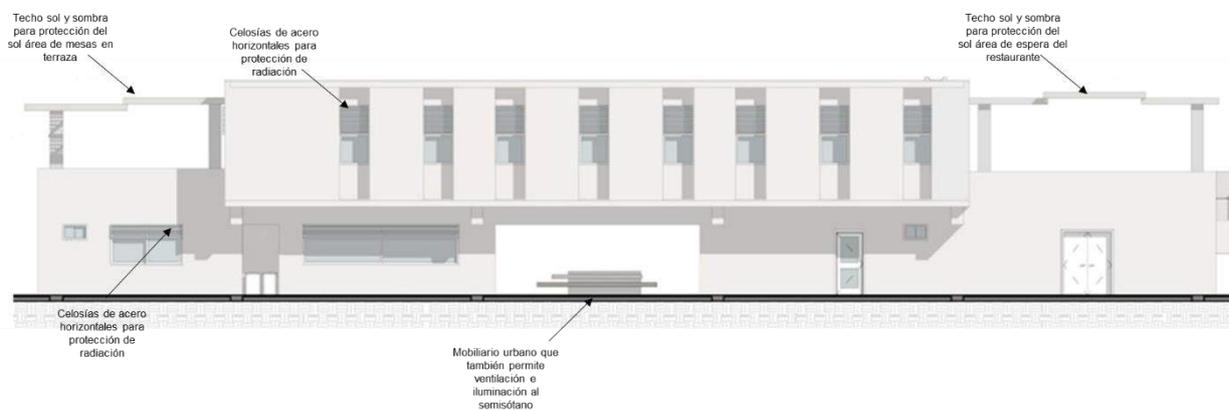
Fachada Norte Restaurante – comercio –vivero
